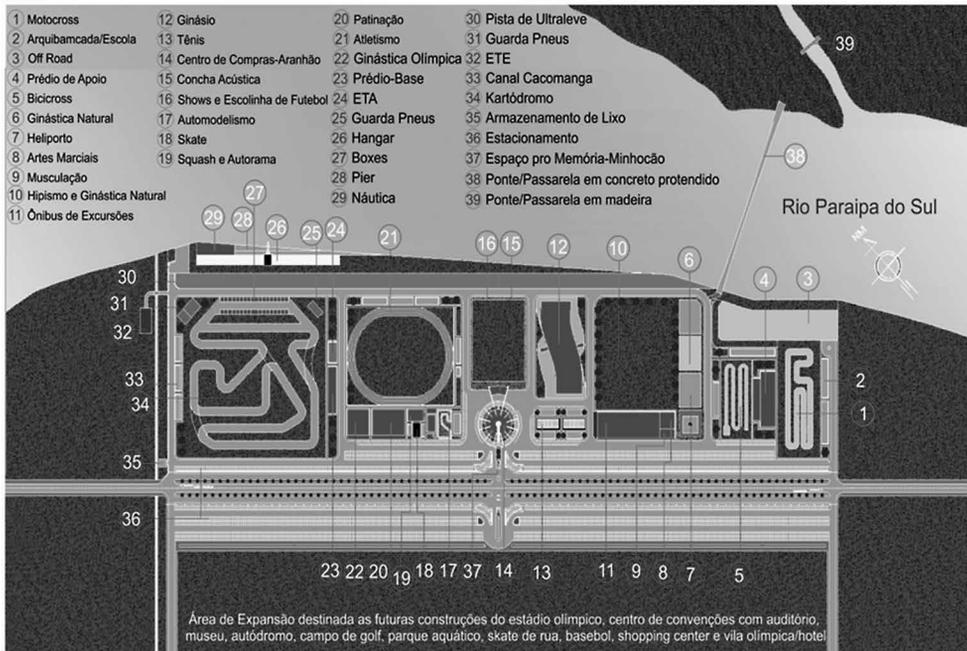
Planta de Situação e Implantação do Complexo/Empreendimento Multiesportivo (lado do Complexo junto ao Rio Paraíba do Sul)
